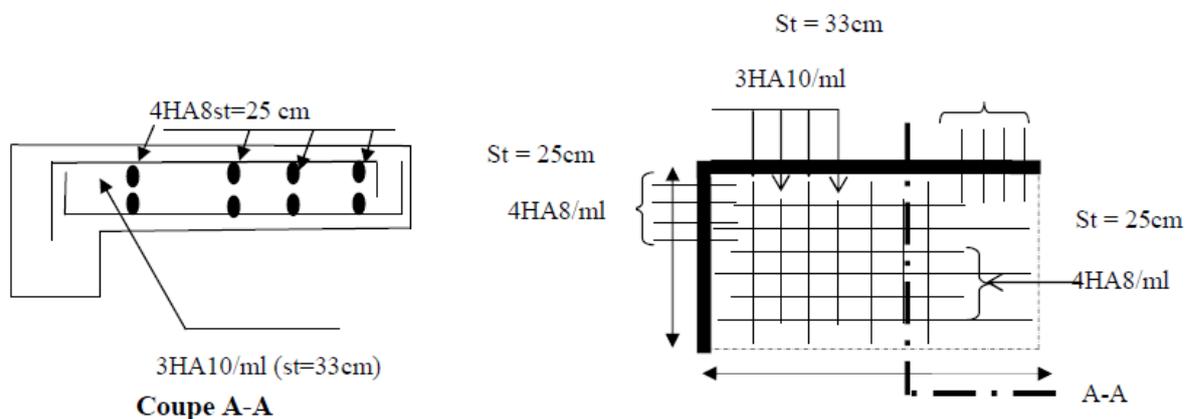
Schéma de ferrailage de la dalle sur 2 appuis
